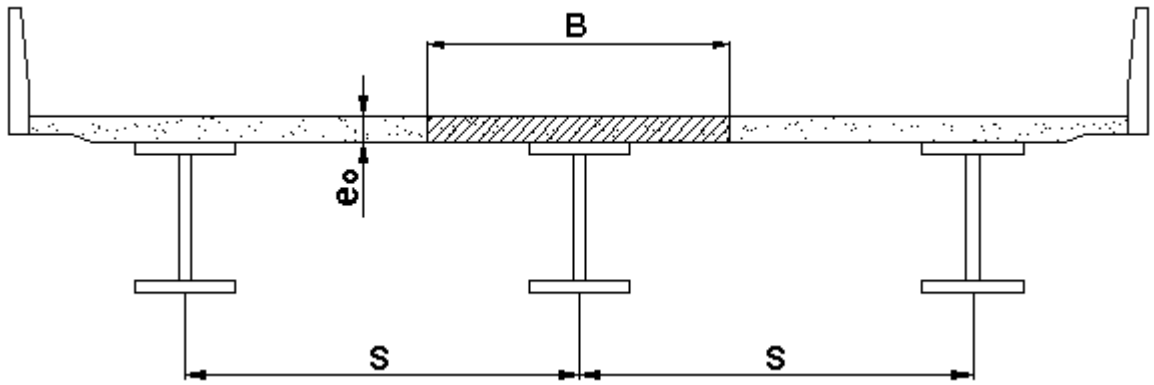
Ancho efectivo de la losa de hormigón para una viga interior
